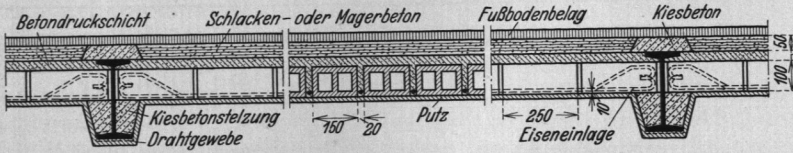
Steineisendecke aus Kleineschen Deckensteinen.
